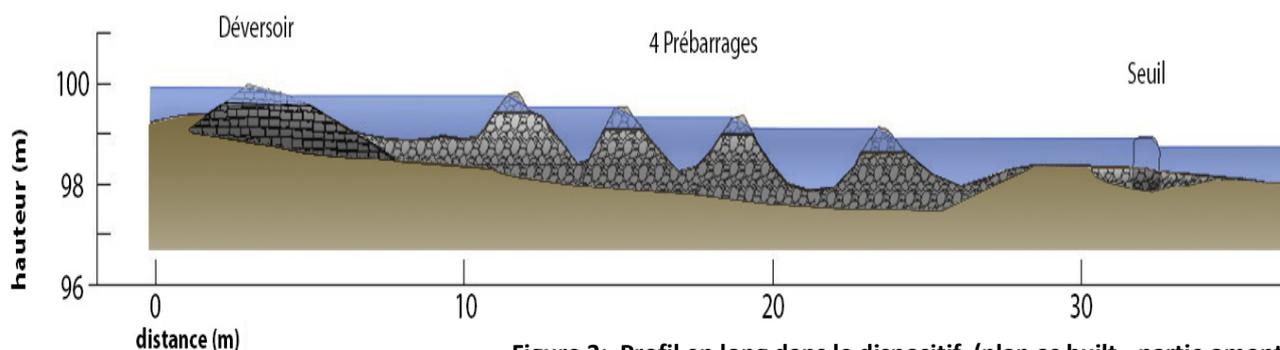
Profil en long dans le dispositif (plan as built - partie amont)
